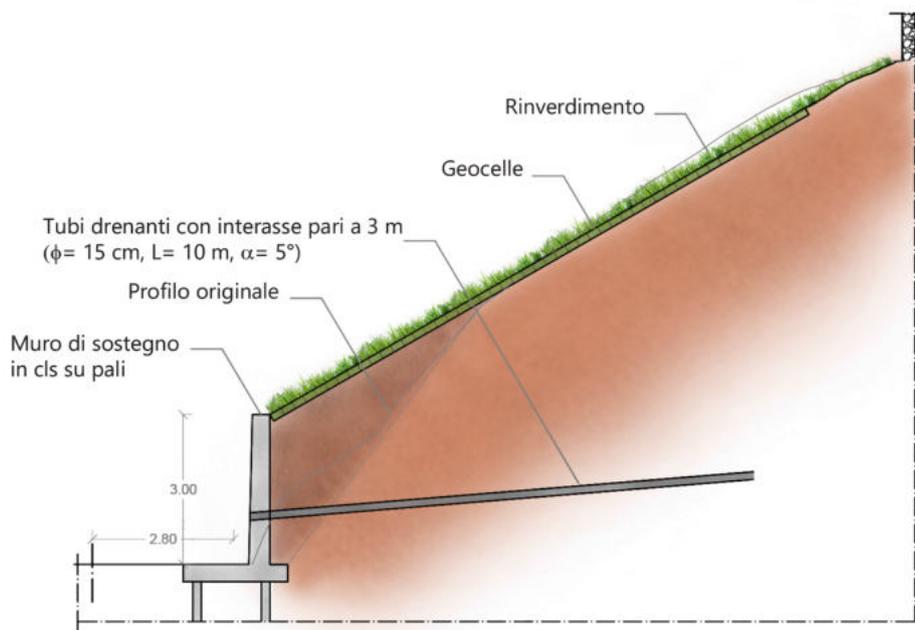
Sezione tipo dell'intervento Pendio post intervento previsto in zona 6 (Ipotesi A).
